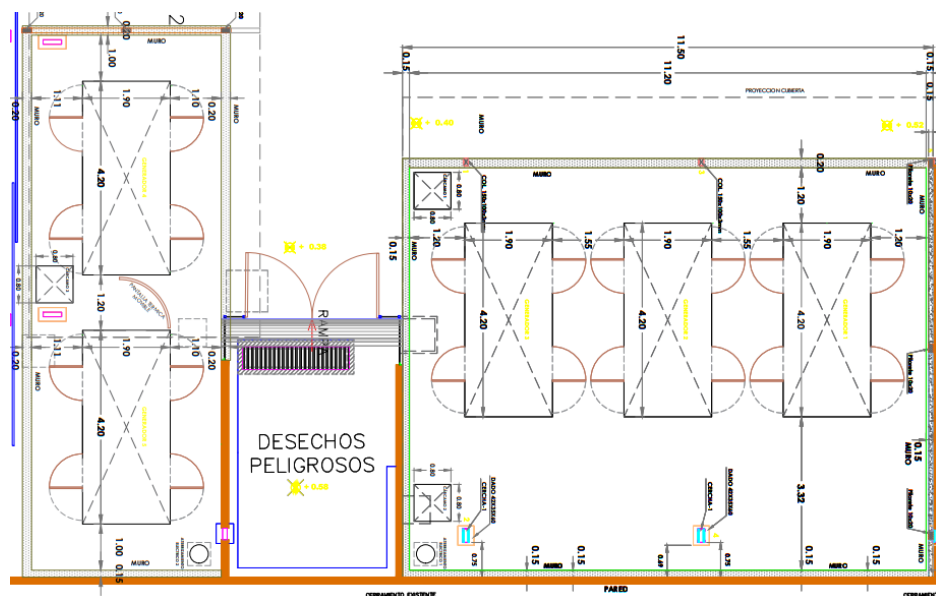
Plano arquitectónico del proyecto [21]
